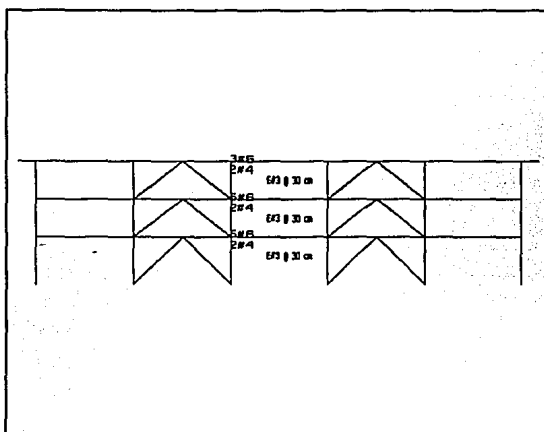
Armados en las vigas del eje A, modelo 4, Q=2
